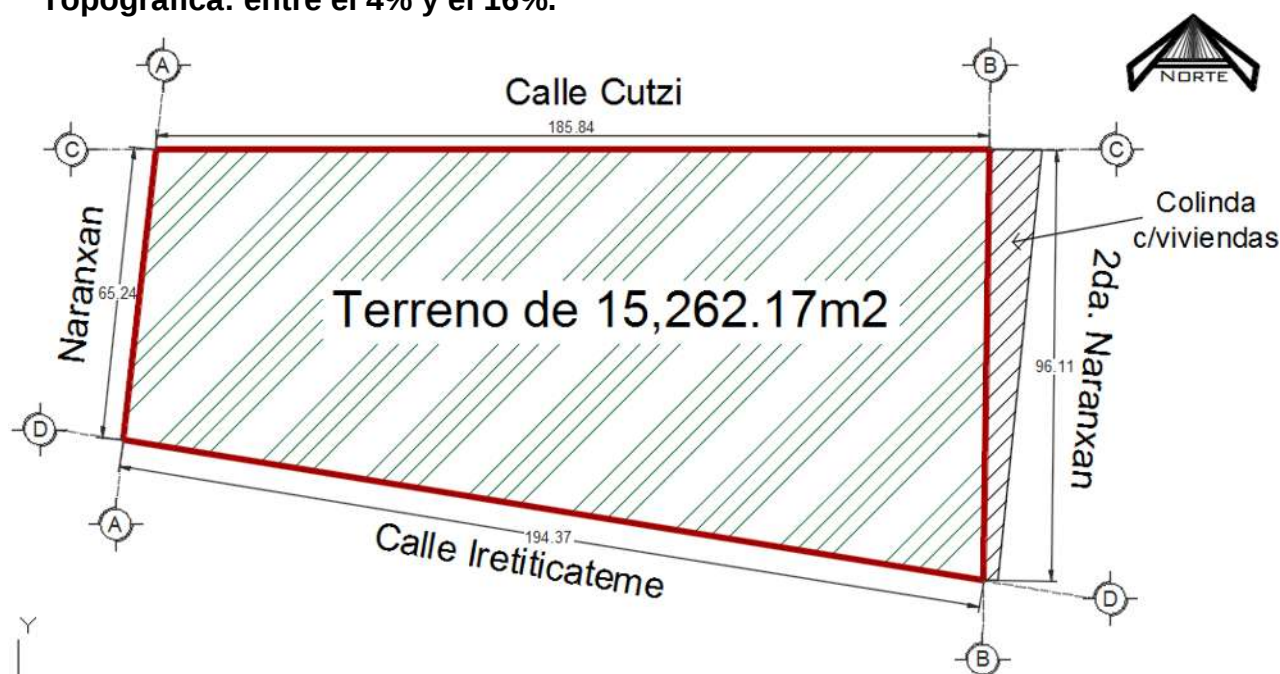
Plano del predio, elaborado por Ramiro D.G. Ayala. Plano con medidas del terreno para pre-dimensionar el espacio.
